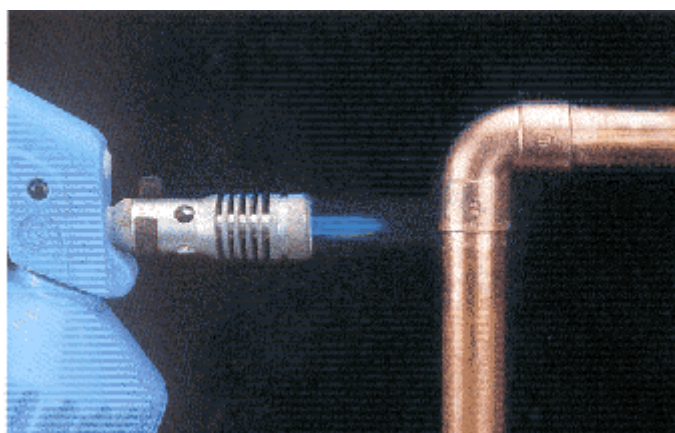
Aplique a chama sobre a conexão para aquecer o tubo e a bolsa da conexão, até que a solda derreta quando colocada na união do tubo com a conexão.
